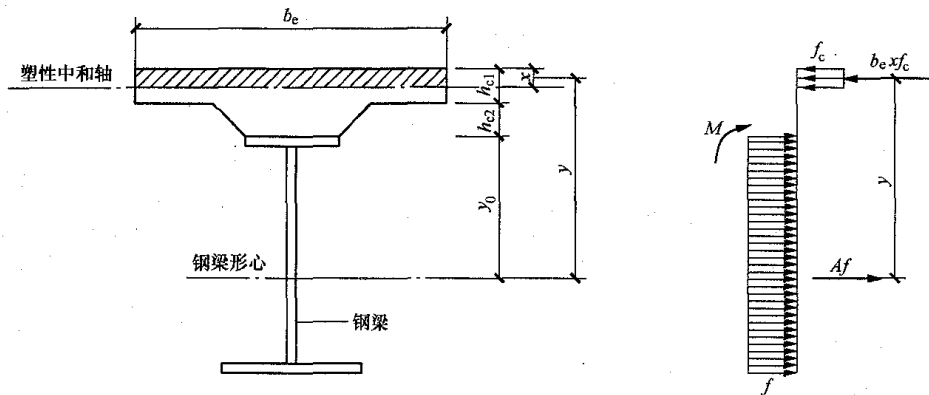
塑性中和轴位于混凝土翼板内组合梁计算简图
